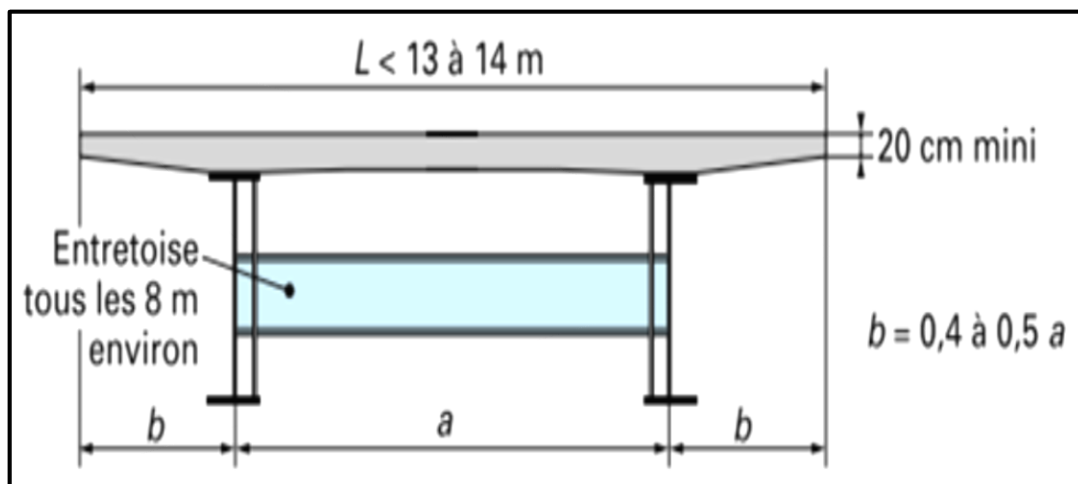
Coupe transversale d'un tablier bipoutre.
